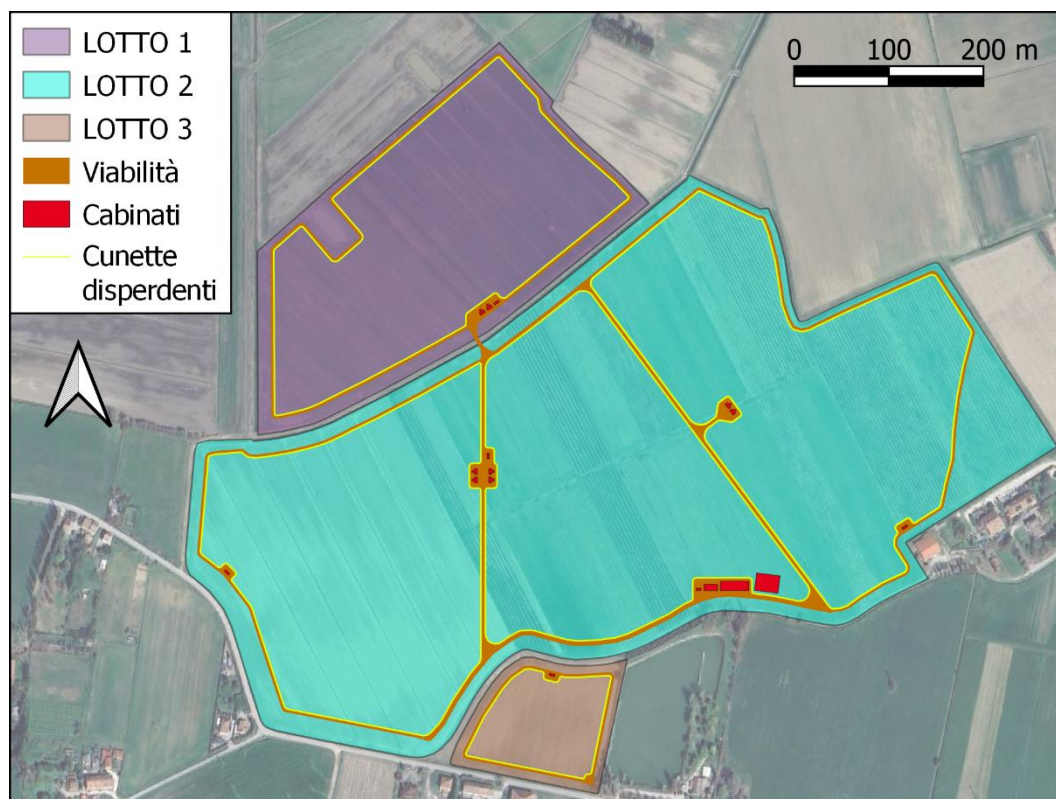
Tracciato planimetrico delle cunette disperdenti
